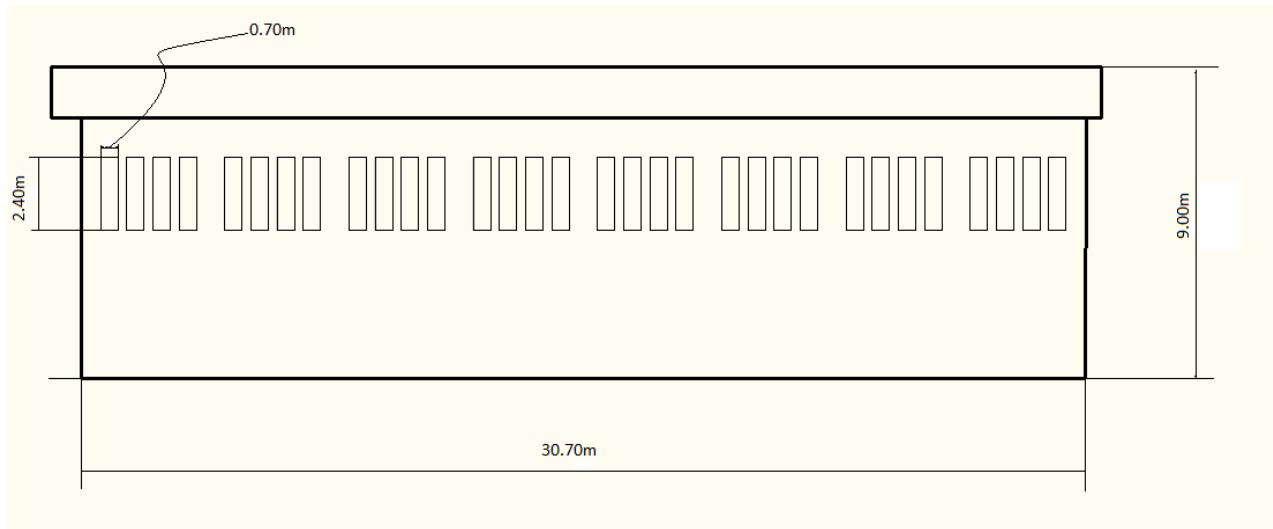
Surfaces des ouvertures sur la façade latérale droite
